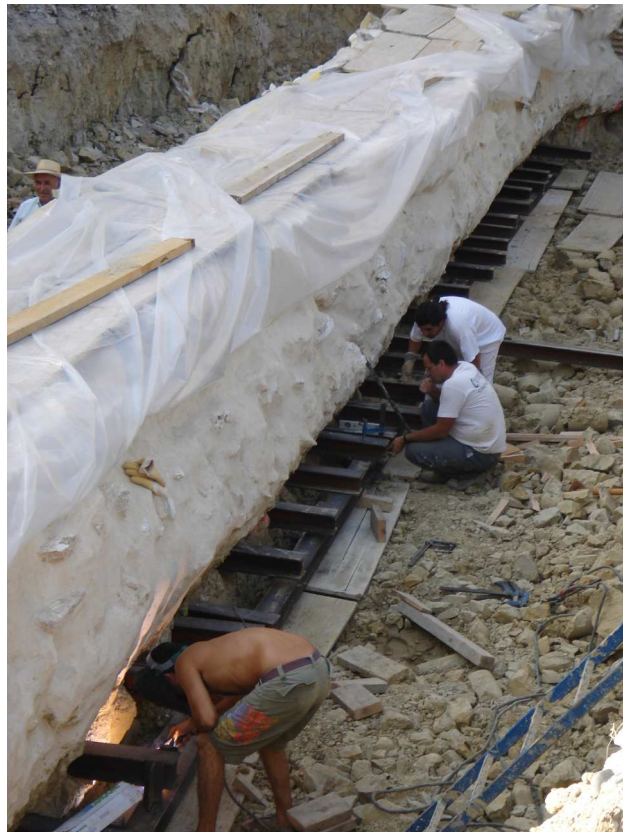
Trabajos de soldadura de las viguetas, ubicadas en las 30 perforaciones bajo Cauce.
